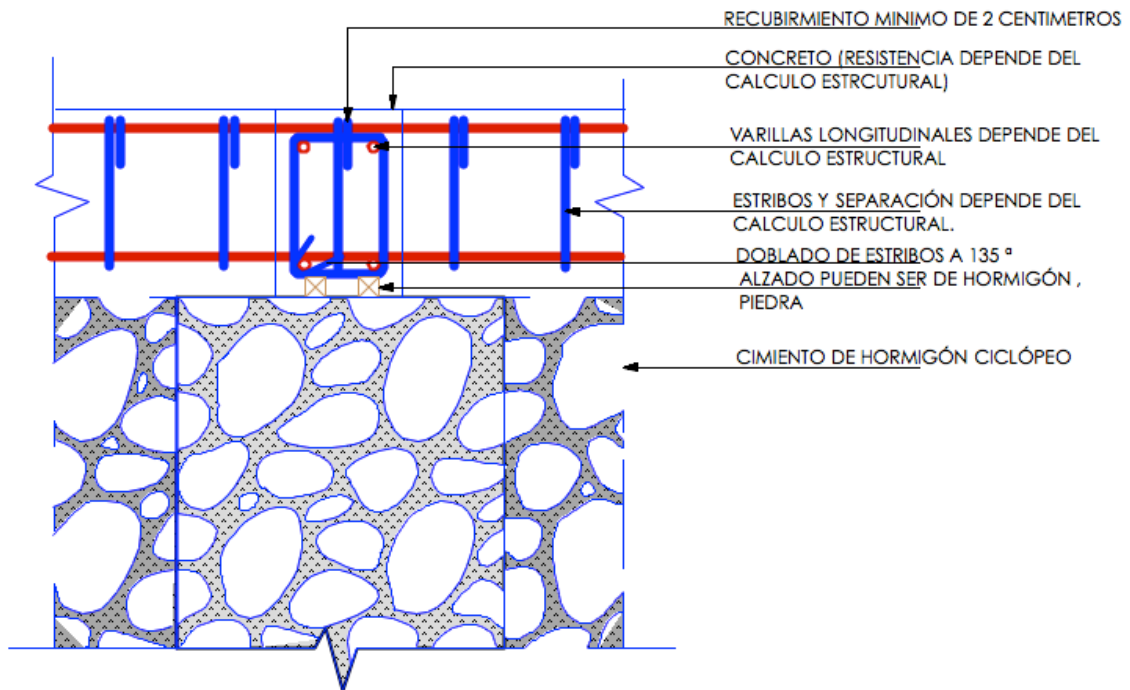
Detalle de unión de columna y cadena de hormigón armado.
